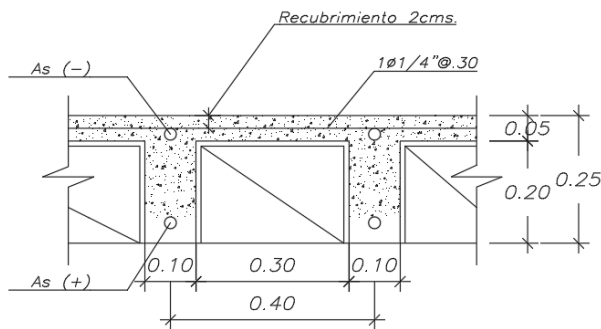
Sección transversal de losa maciza bidireccional H=25cm
